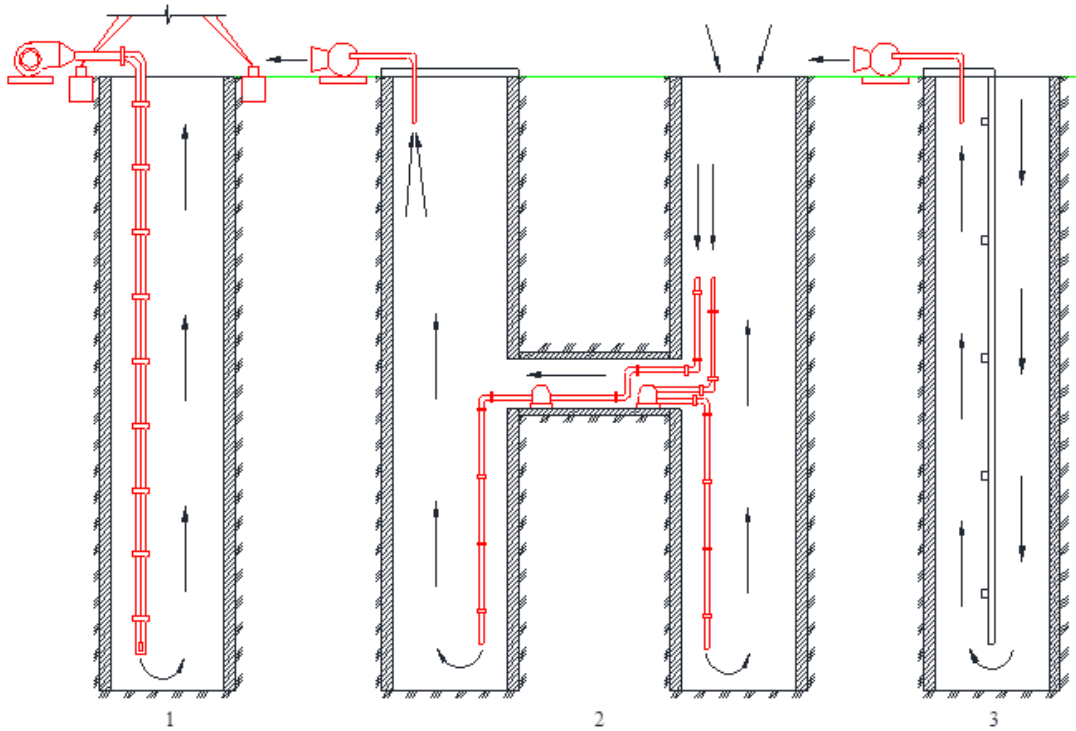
Штучна вентиляція шахтних стволів [90] з подачею повітря: трубами 1, наскрізним струменем 2 з поздовжньою перемичкою 3.
